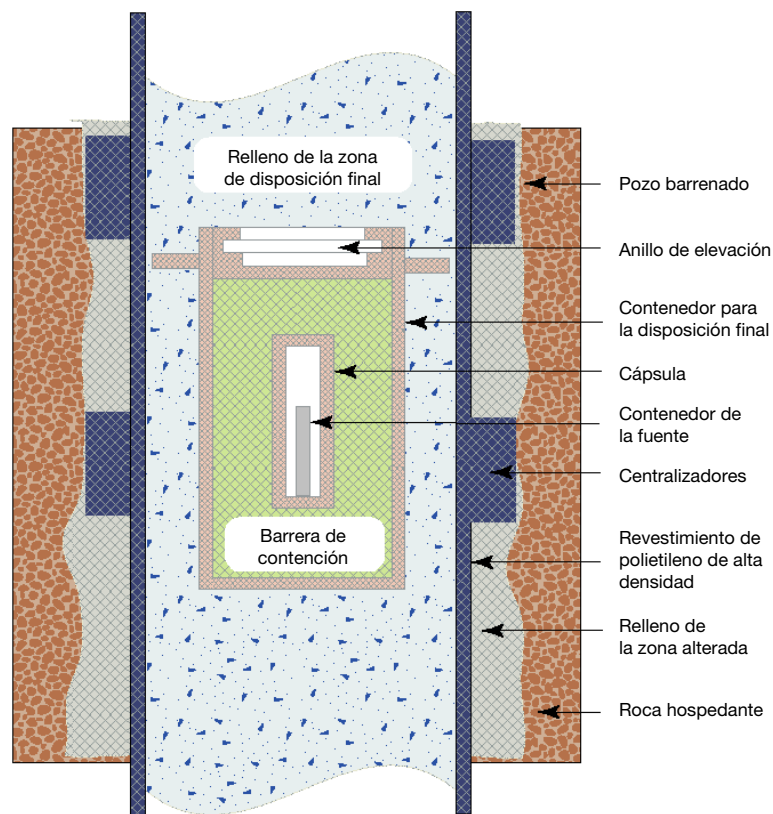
Ilustración esquemática de los posibles componentes de un sistema de disposición final en pozos barrenados.
